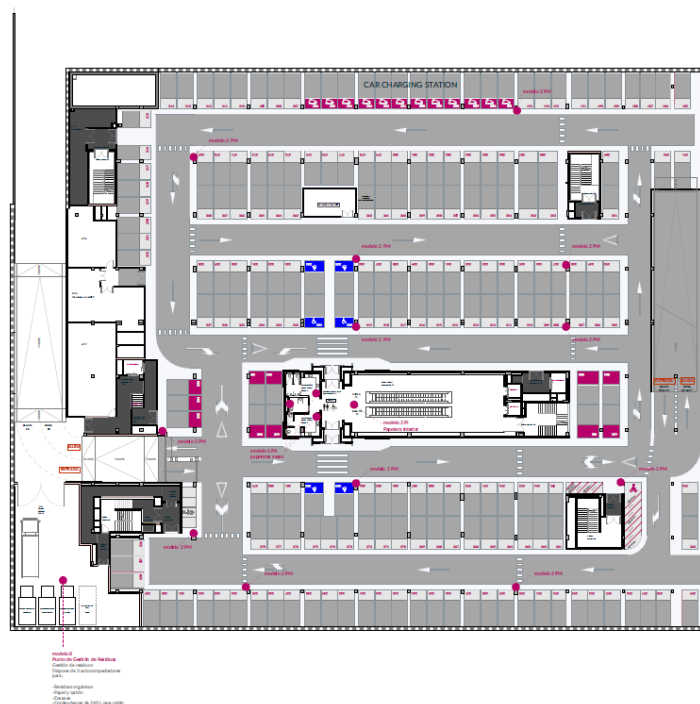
Plano de ubicación de papeleras para residuos y reciclaje
